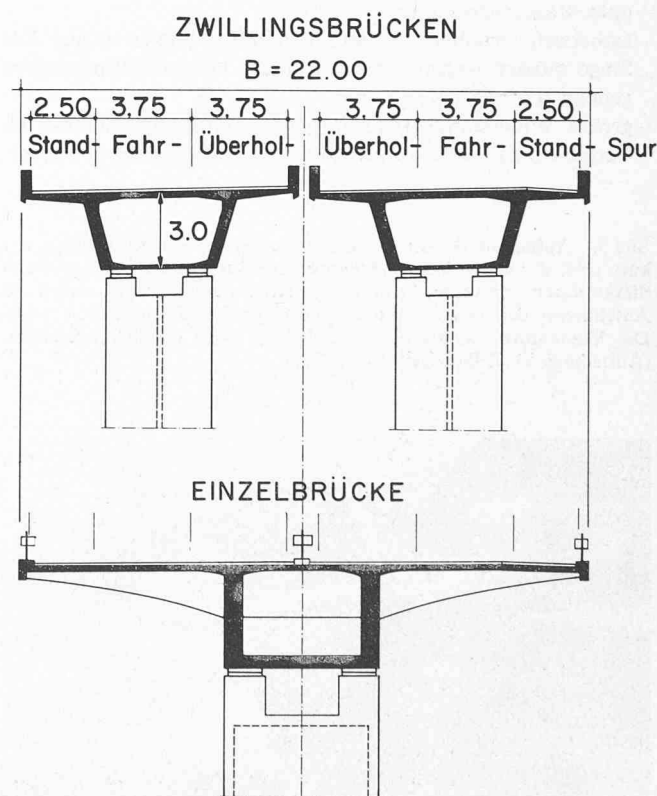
Zwillingsbrücken/Einzelbrücke mit eingetragenen Fahr-, Überhol- und Standspuren. Vergleich der Konzepte
